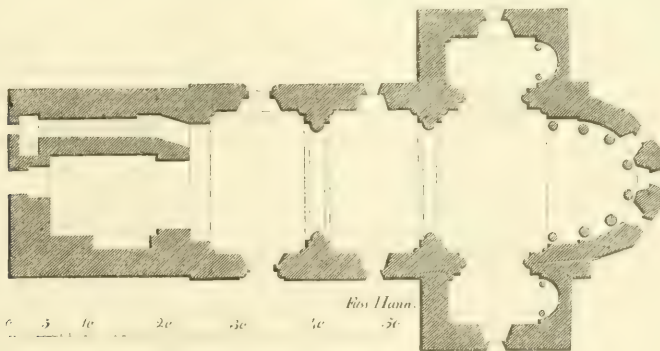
Kirche zu Idensen. Grundriss.
